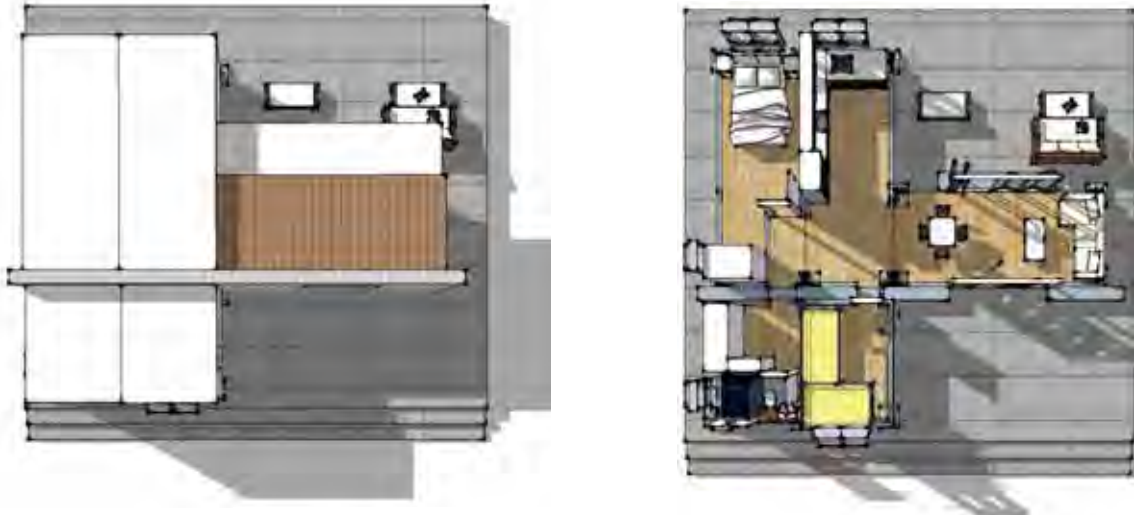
Plantas Vivienda SME. Fuente: Propia
